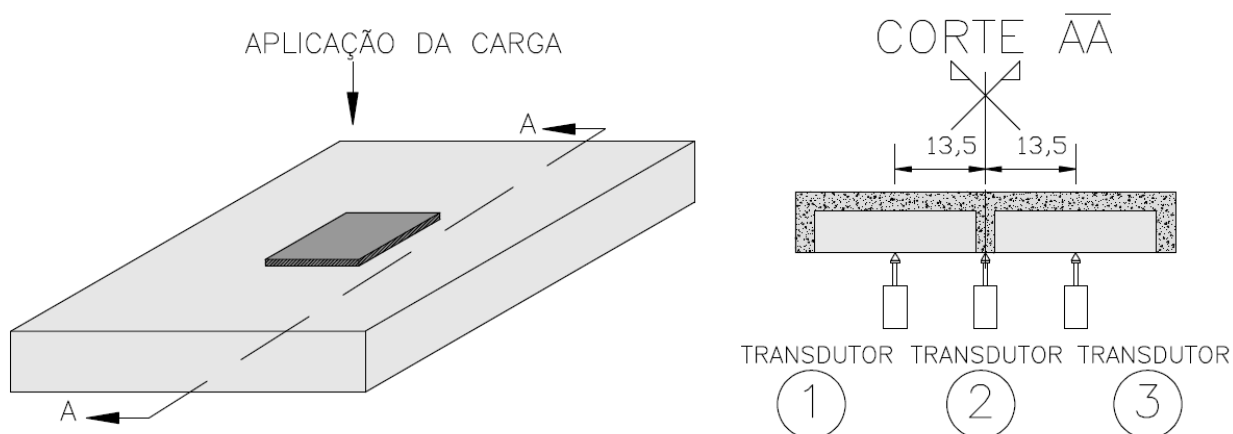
Detalhe do posicionamento dos transdutores utilizados nos ensaios das vigas
